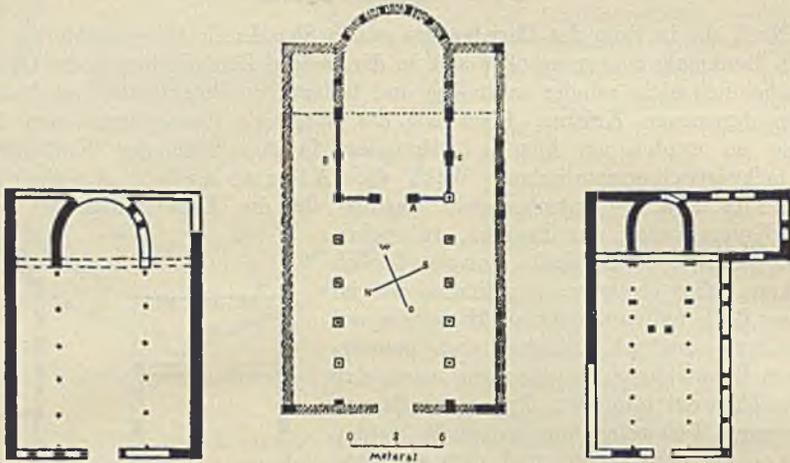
Grundrisse nordafrikanischer Basiliken. (Nach Witting)
